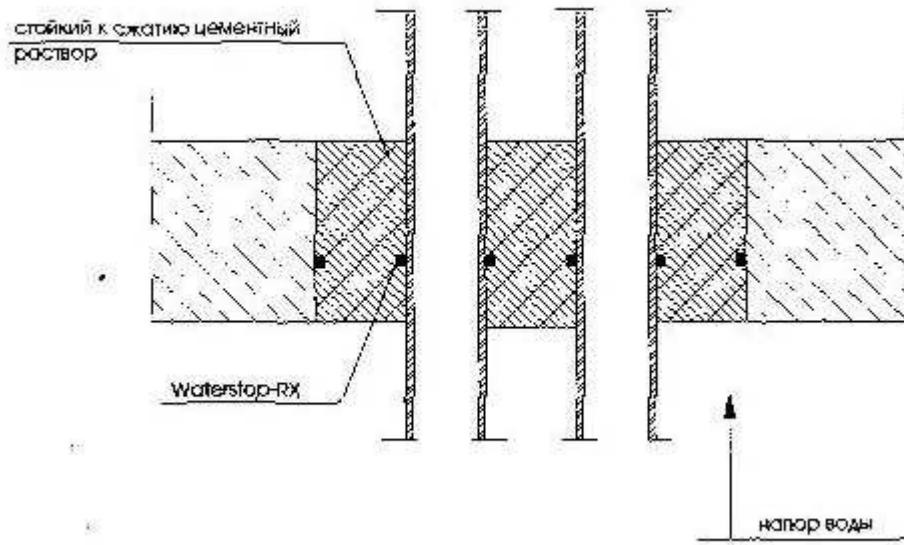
Способ установки бетонитового шнура на трубах
